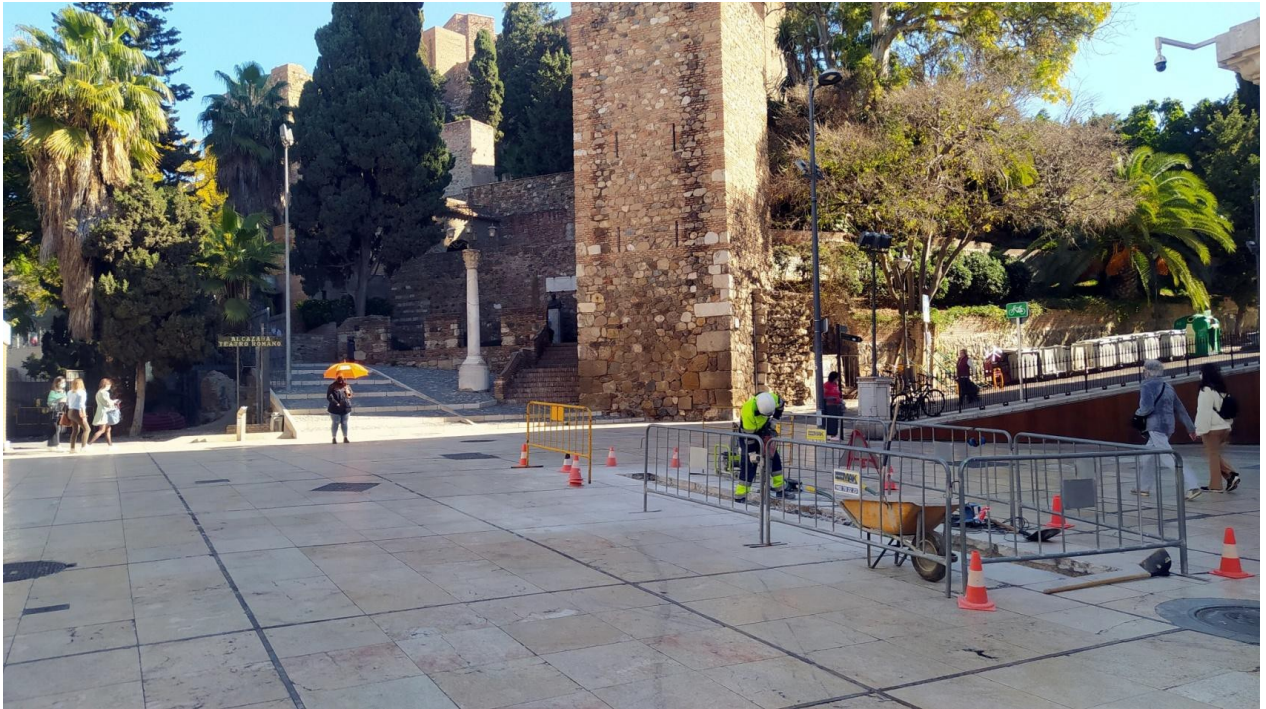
Primer tramo de la Zanja 1, en el extremo sur del trazado.
